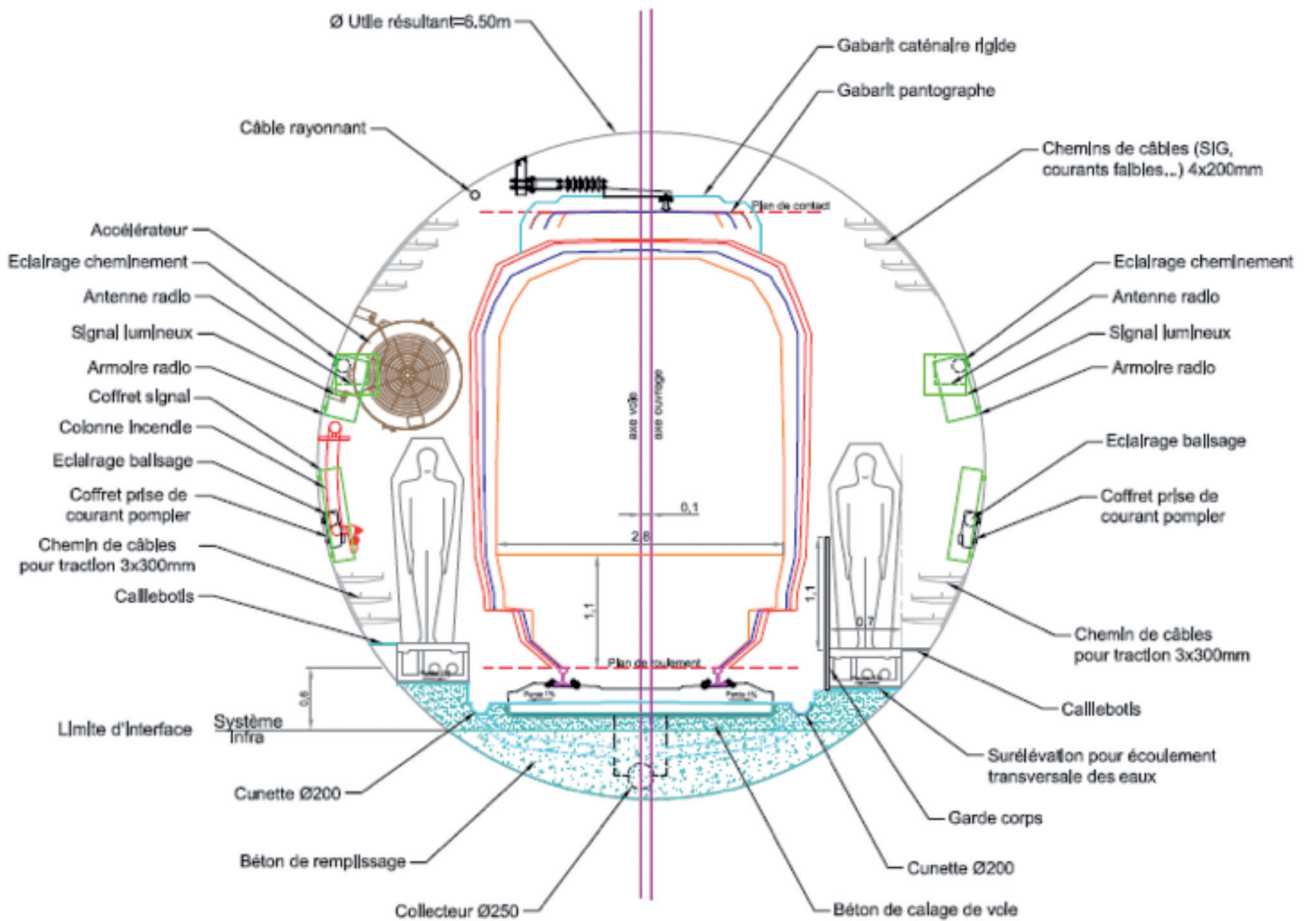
Coupe Tunnel monovoie Ø 6,5 mètres
